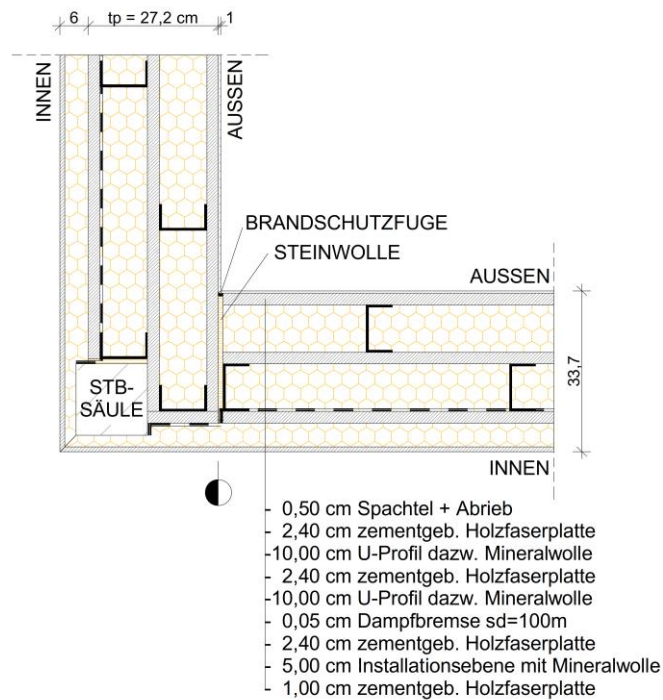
Grundriss Innenecke (mit Stahlbetonecksäule)
